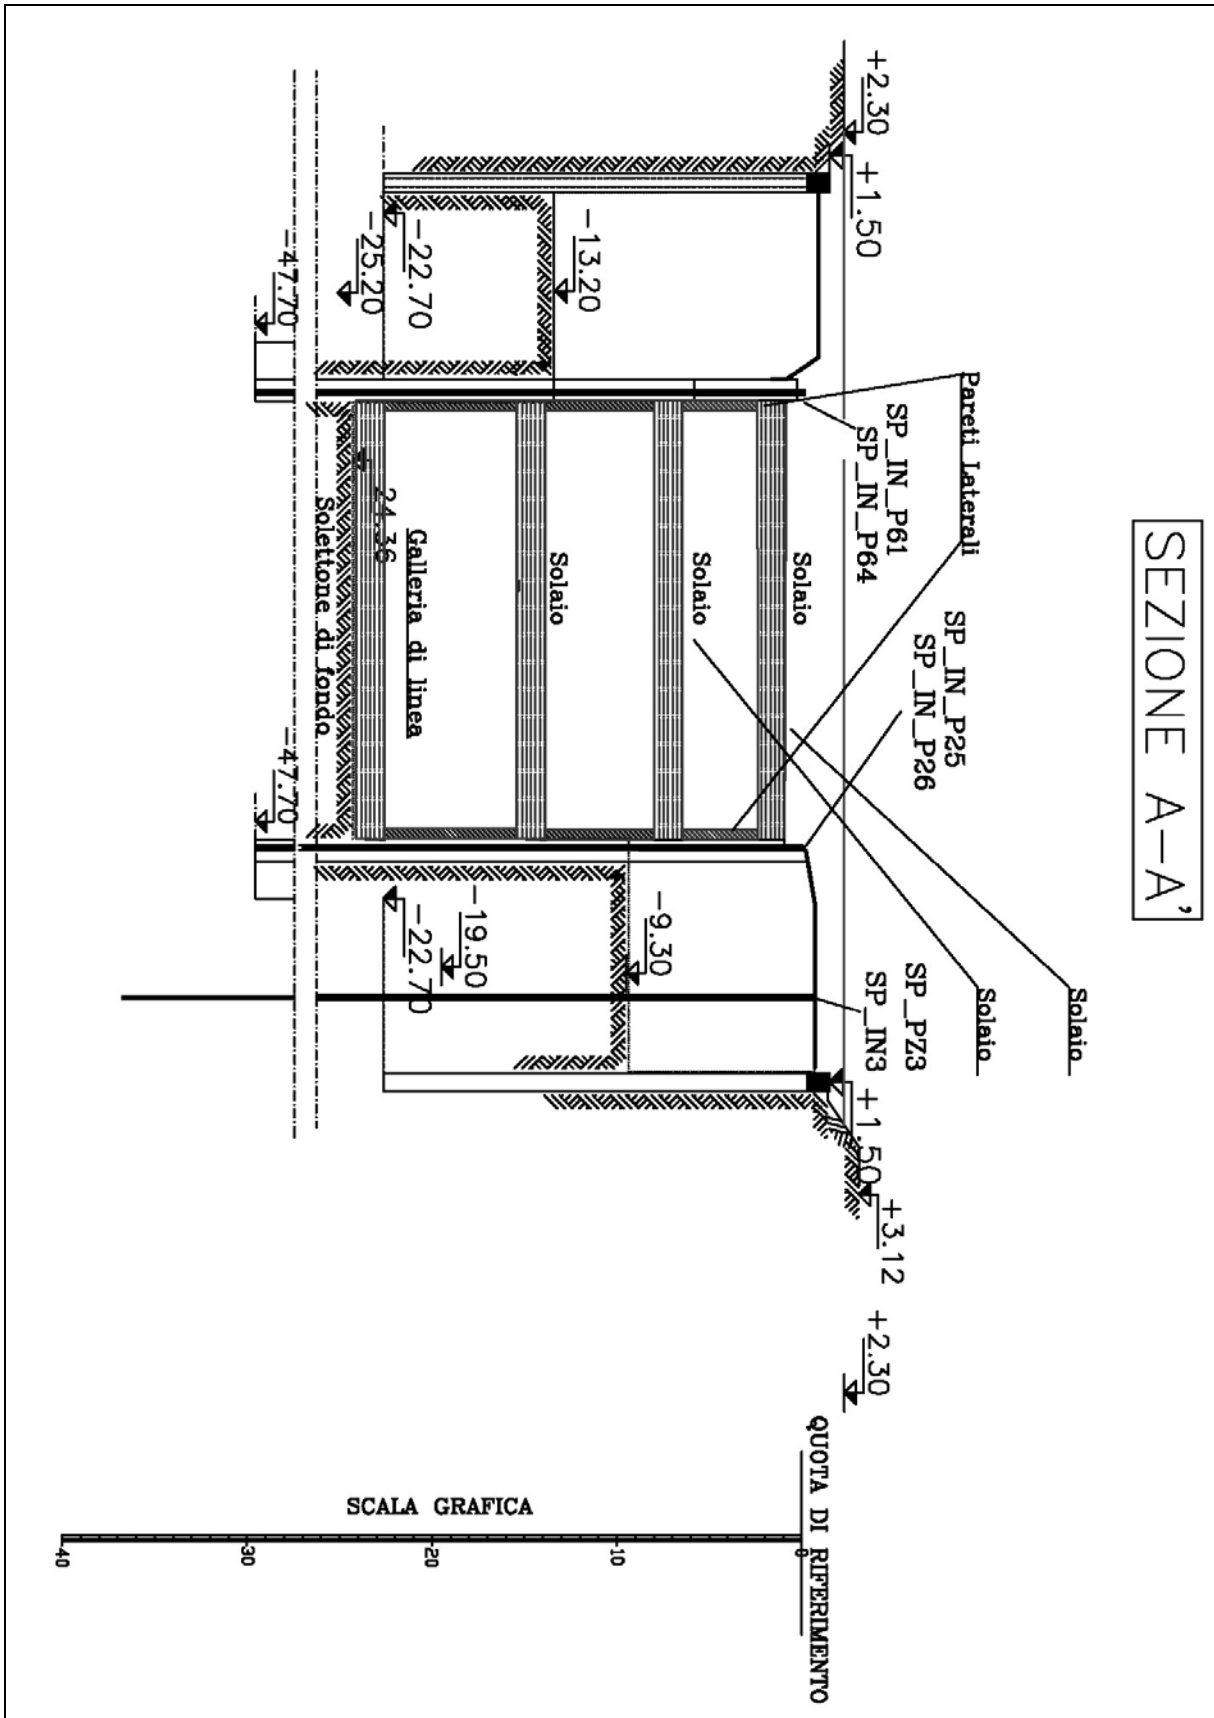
Sezione A-A' pozzo stazione, raffigurante la suddivisione in aree di lavoro.
